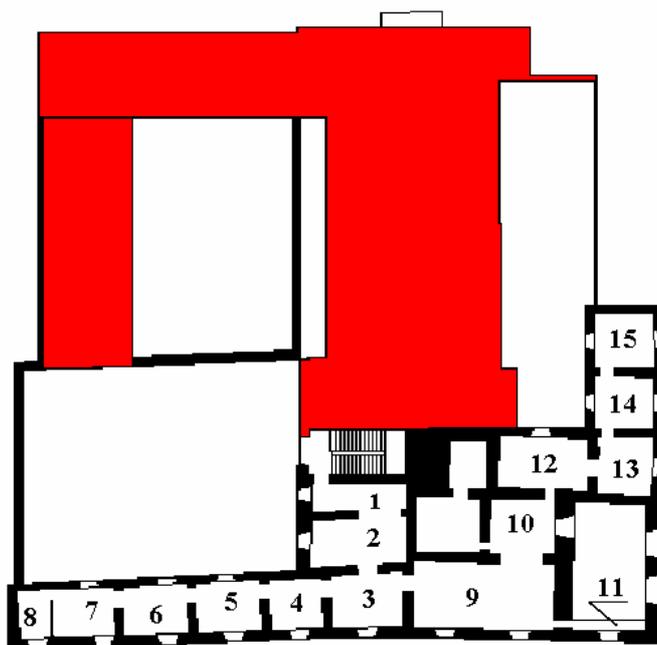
Schema planimetrico dell'ala settecentesca e dell'ala antica.
